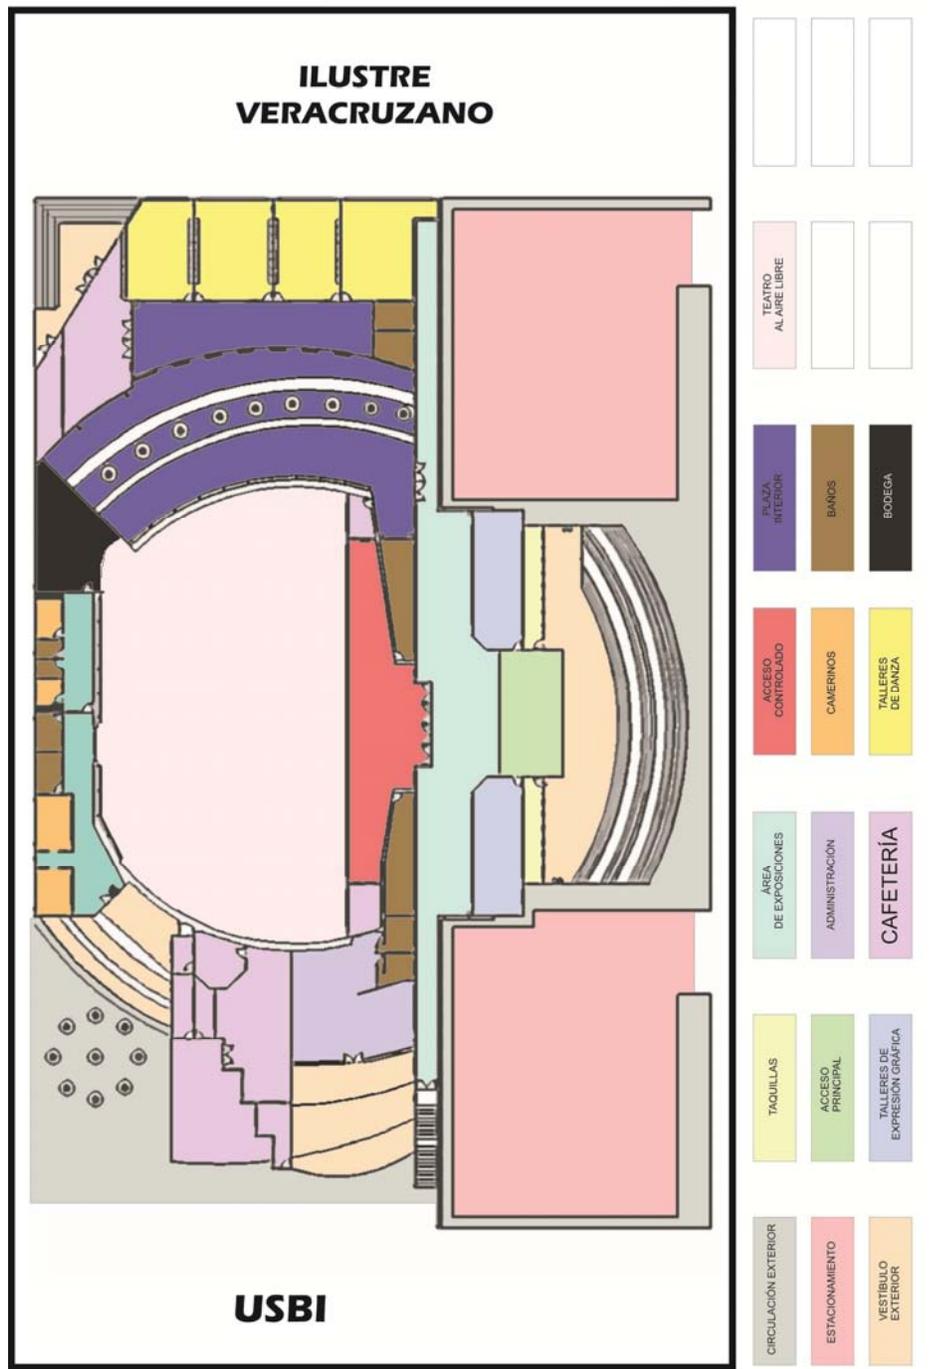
, se muestra el ejercicio formal de la planta arquitectónica.
